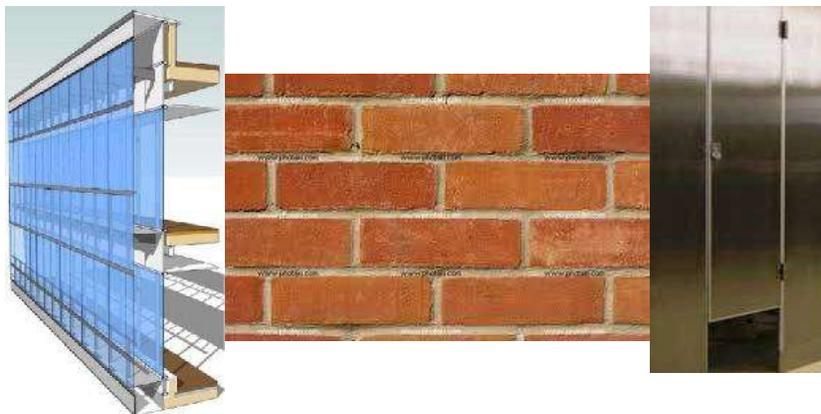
/muros de ladrillo, cortinas de vidrio y mampara de acero/foto obtenida de <https://www.google.com>
